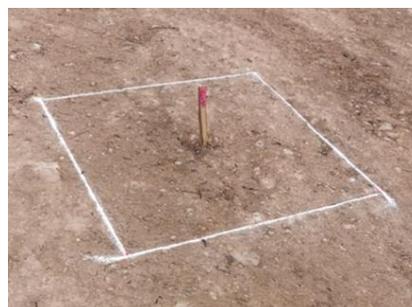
Marcaje de Zapatas Aisladas Nave 3
